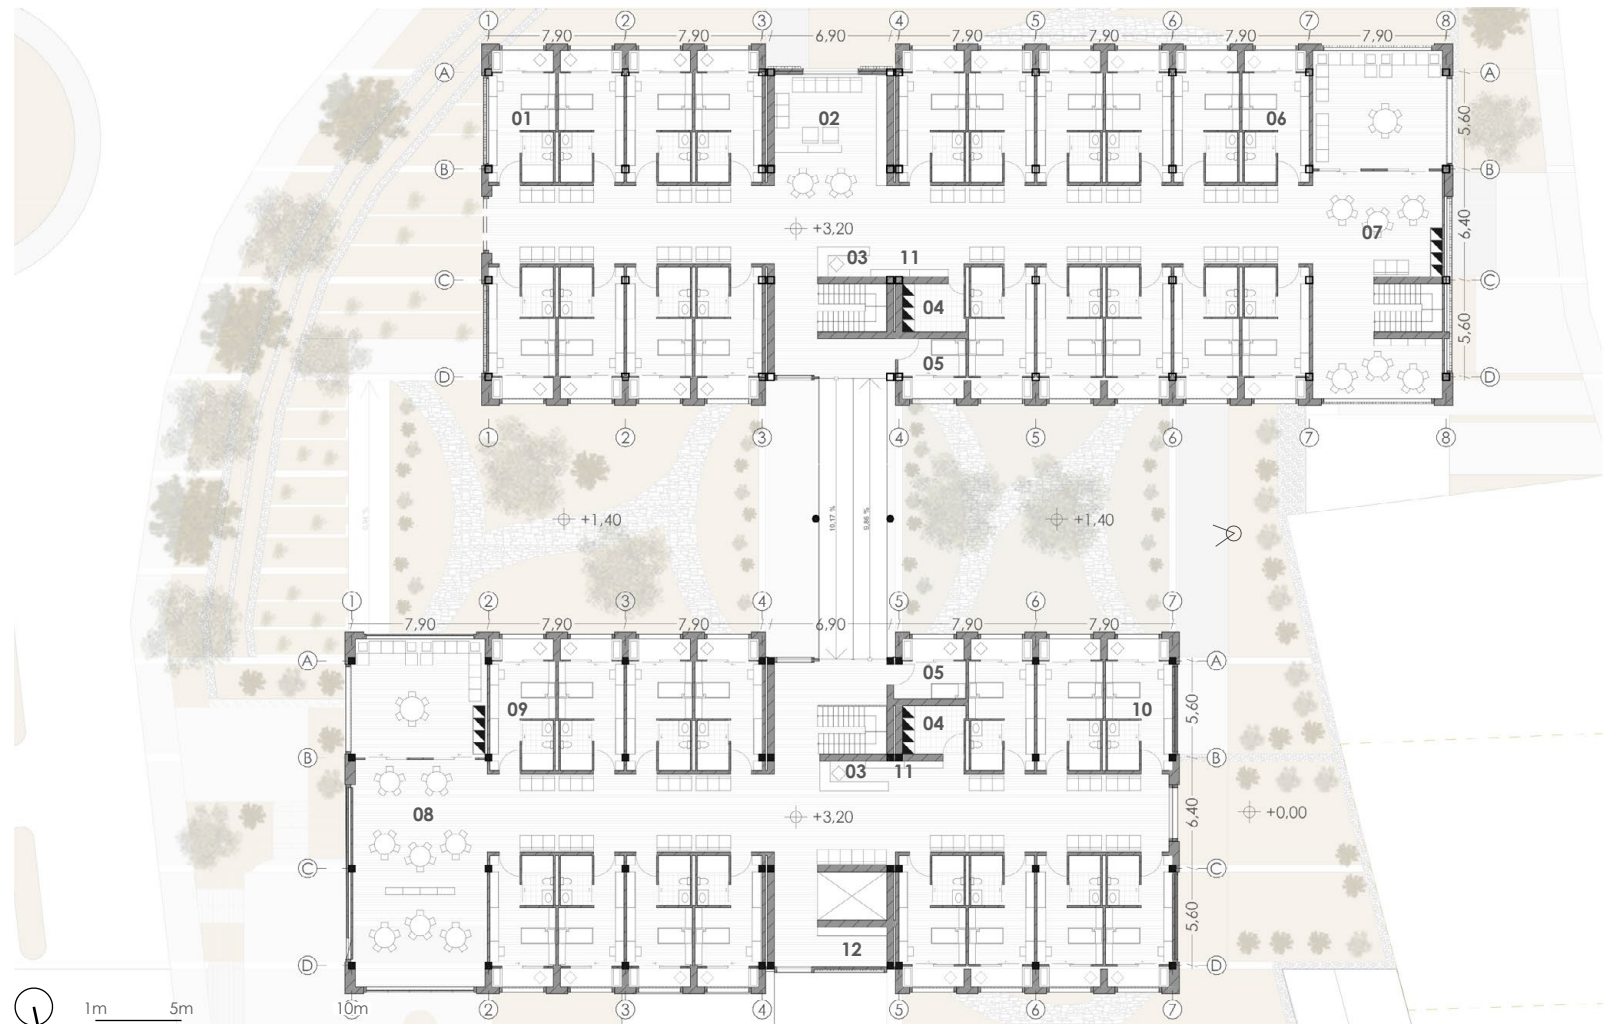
Planta Alta B-C. Fuente: Autoría propia.
